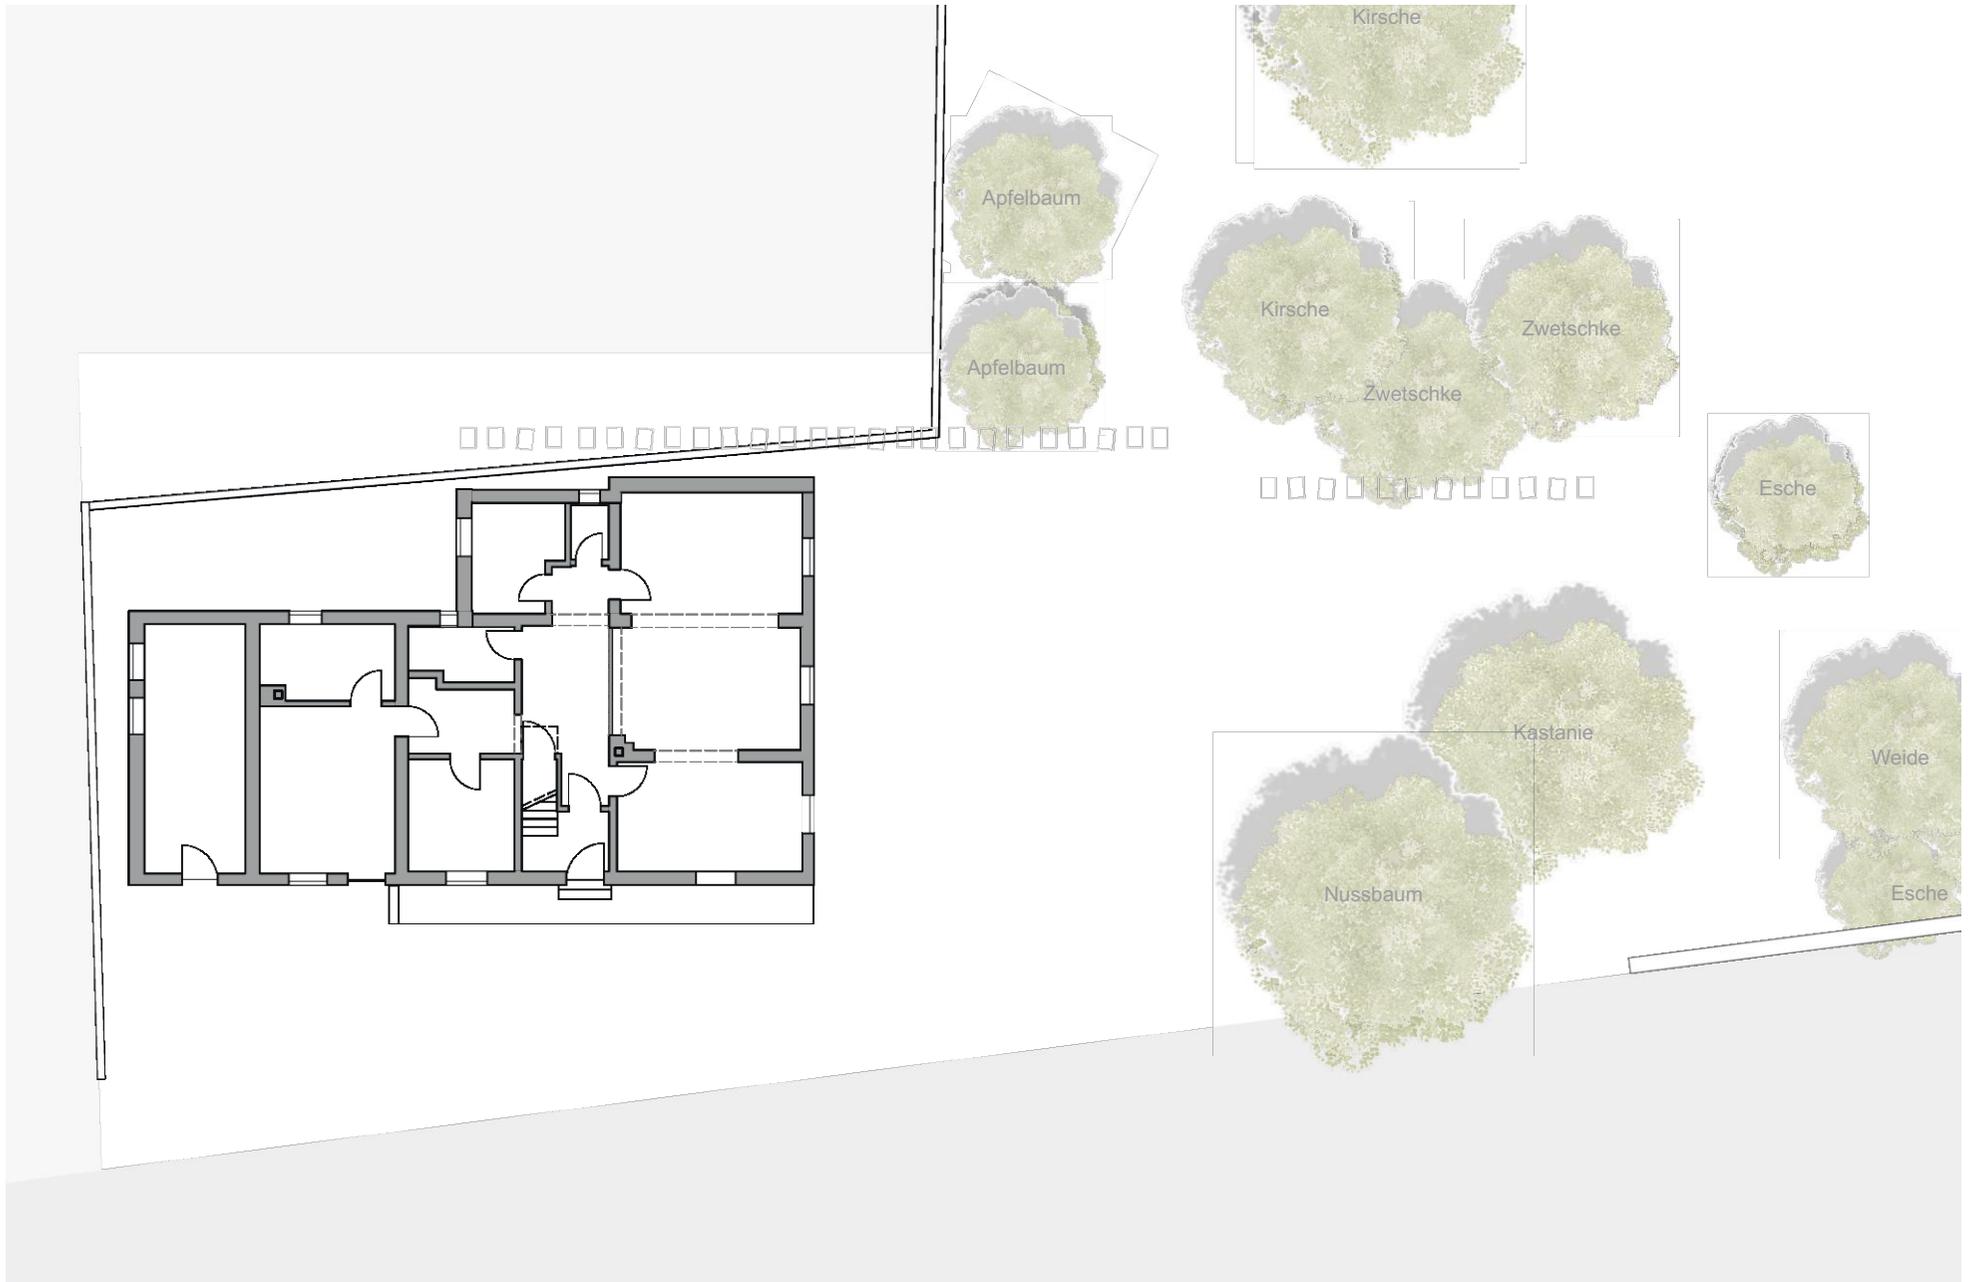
Grundriss Erdgeschoss Bestandsaufnahme 2019 (eigene Abbildung)
